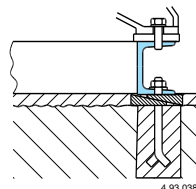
Фундамент для агрегата на опорной плите из сварного профиля.
